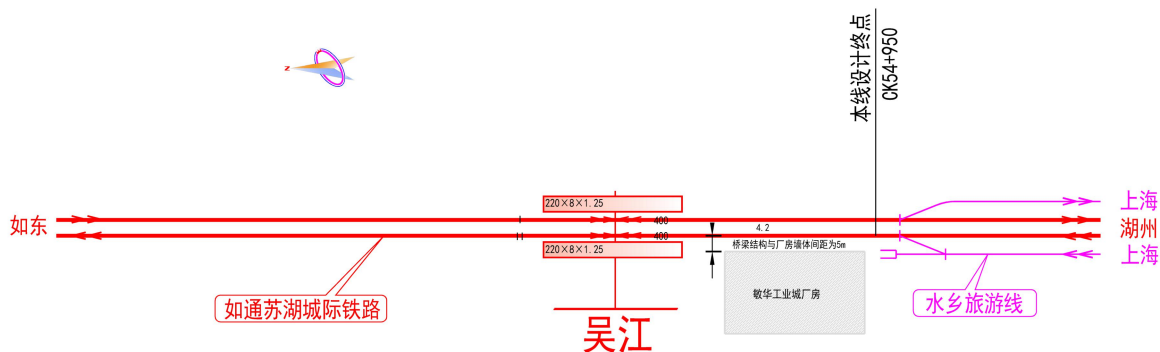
水乡旅游线区间接轨方案平面布置示意图
